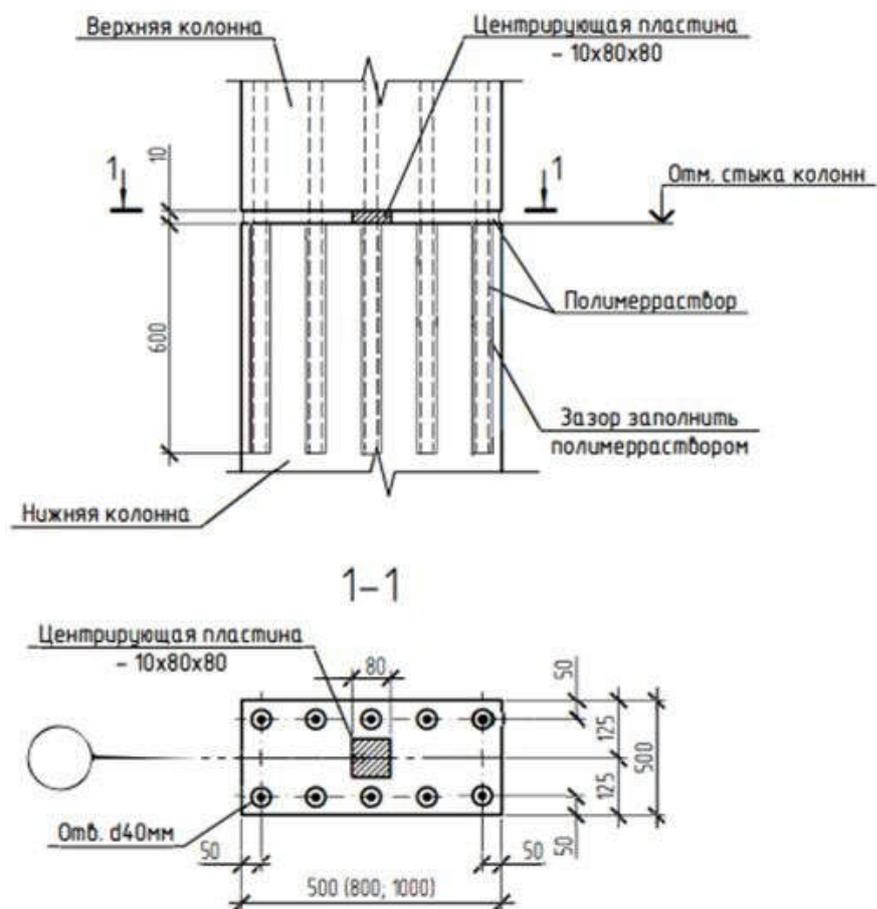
Схема штепсельного соединения с выпусками арматуры нижней части
